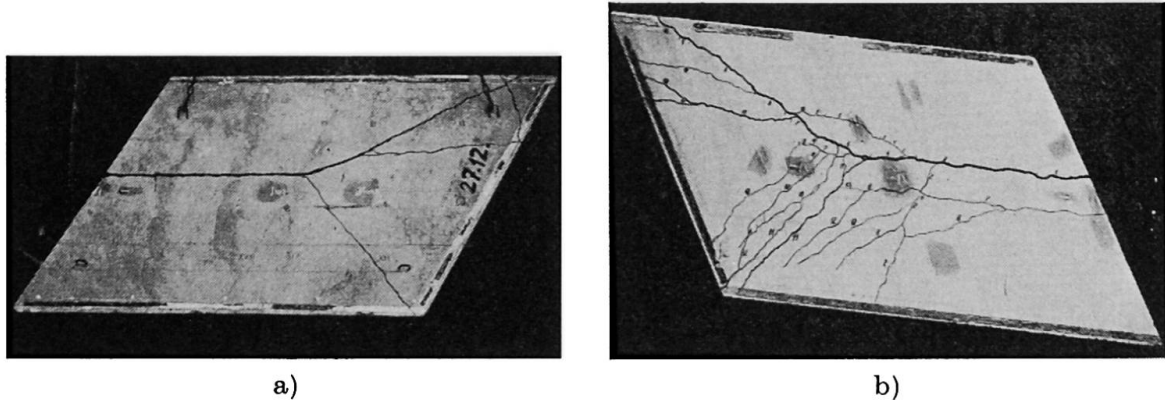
Fissures sur la face a) supérieure et b) inférieure de la dalle oblique avec appui articulé le long de trois côtés. Dalle n° 2.
